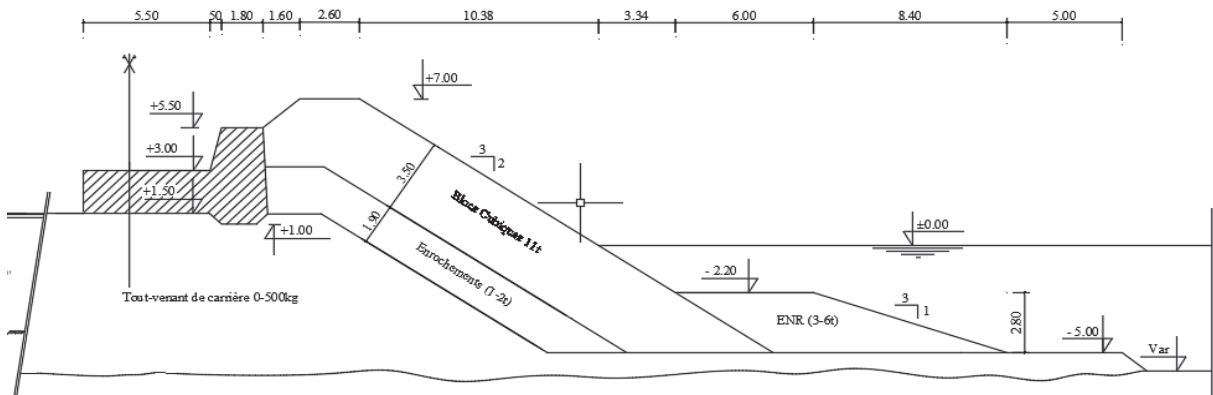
Coupe transversale 2 du profil enracinement de la jetée principale
